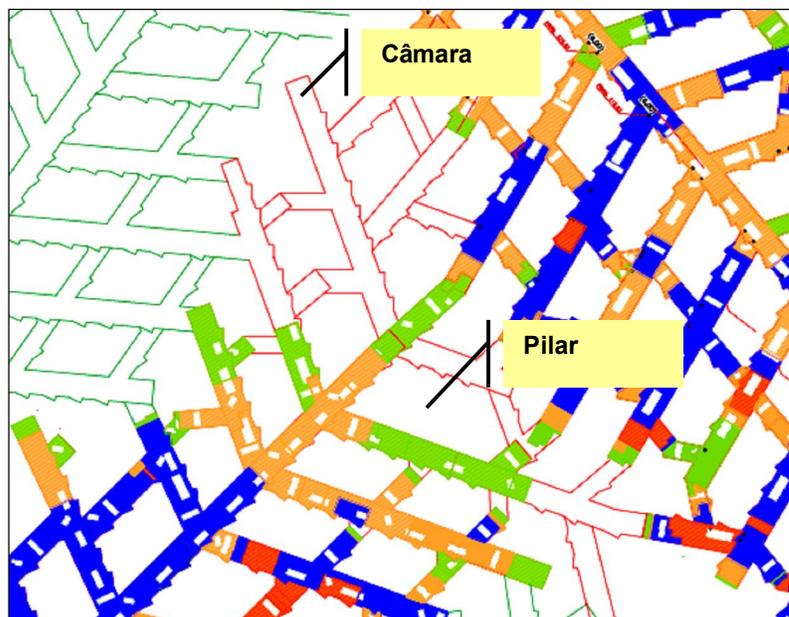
Layout das Câmaras e Pilares no Painel
